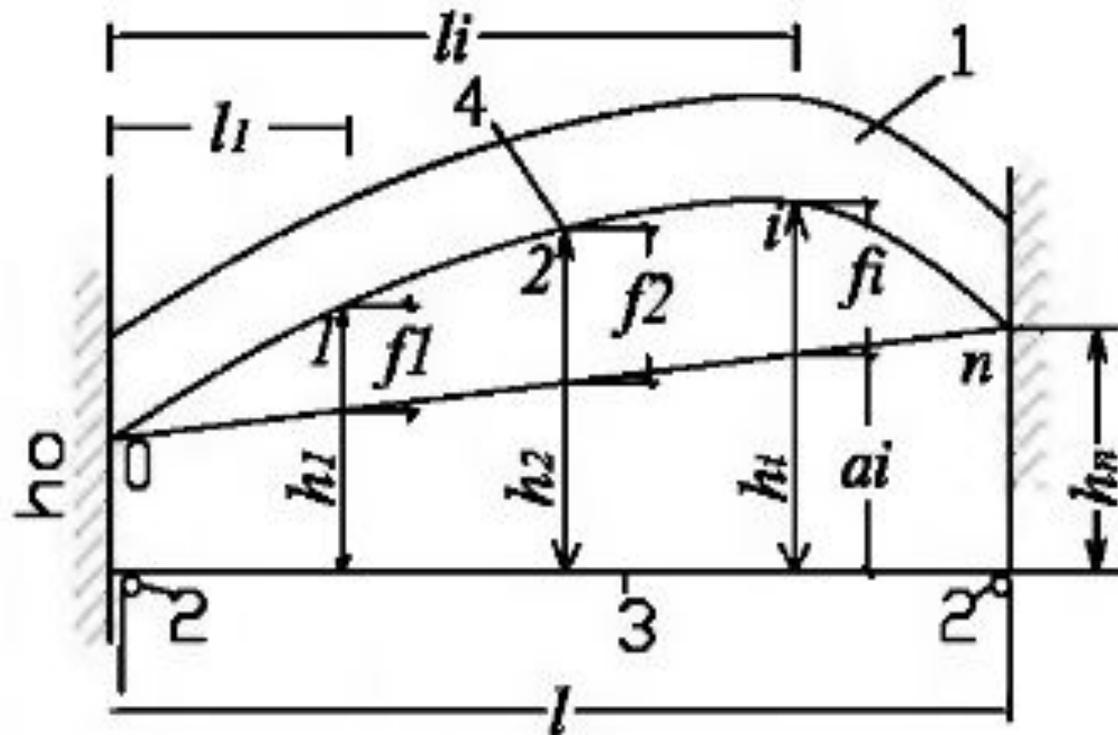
5. Определение прогибов перекрытий и выгибов стен с помощью горизонтальной нити
